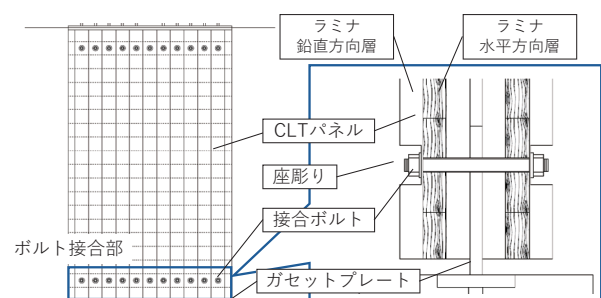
CLT 耐震壁の立面図と接合部鉛直断面図
